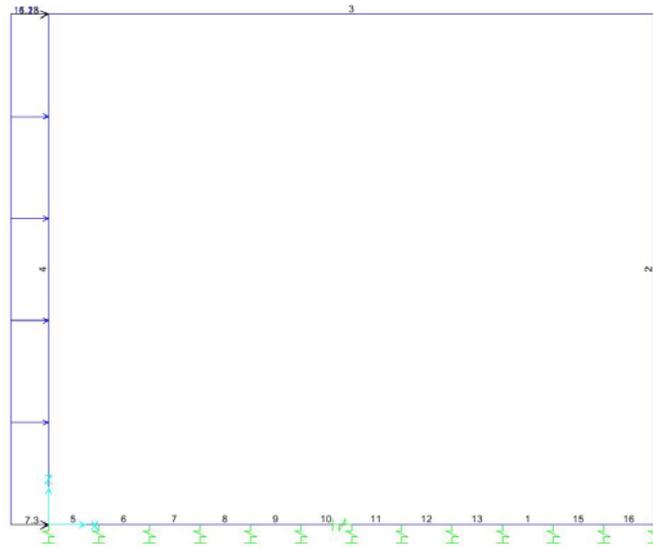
Spinta del sovraccarico accidentale sul rilevato SPACCSX.
